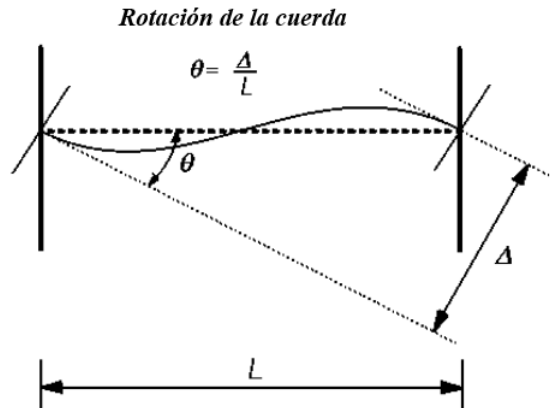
Rotación de viga de acoplamiento entre muros de concreto
